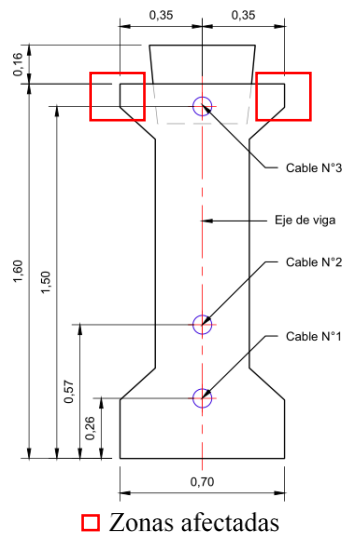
Sección transversal Viga No.1 Puente 8, Tramo 9.
